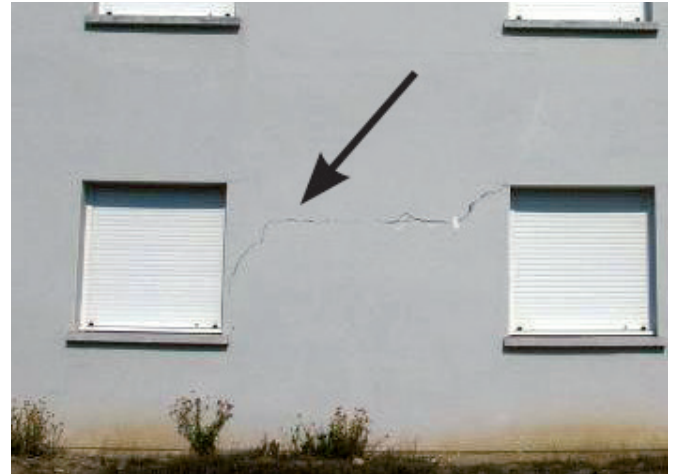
Le pignon de cet immeuble relativement lourd s'enfonce. La façade se fissure. La portance du sol est insuffisante. Les fondations ont été sous-dimensionnées.
